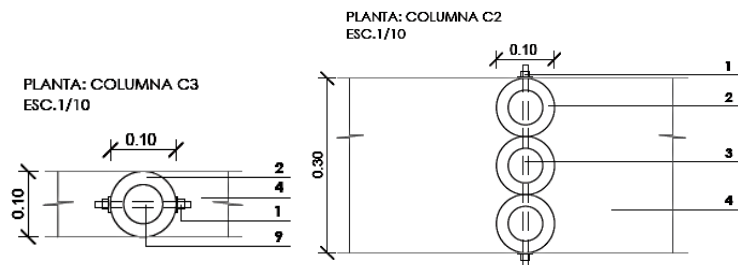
Planta de columnas secundarias. Fuente: Elaboración propia.
